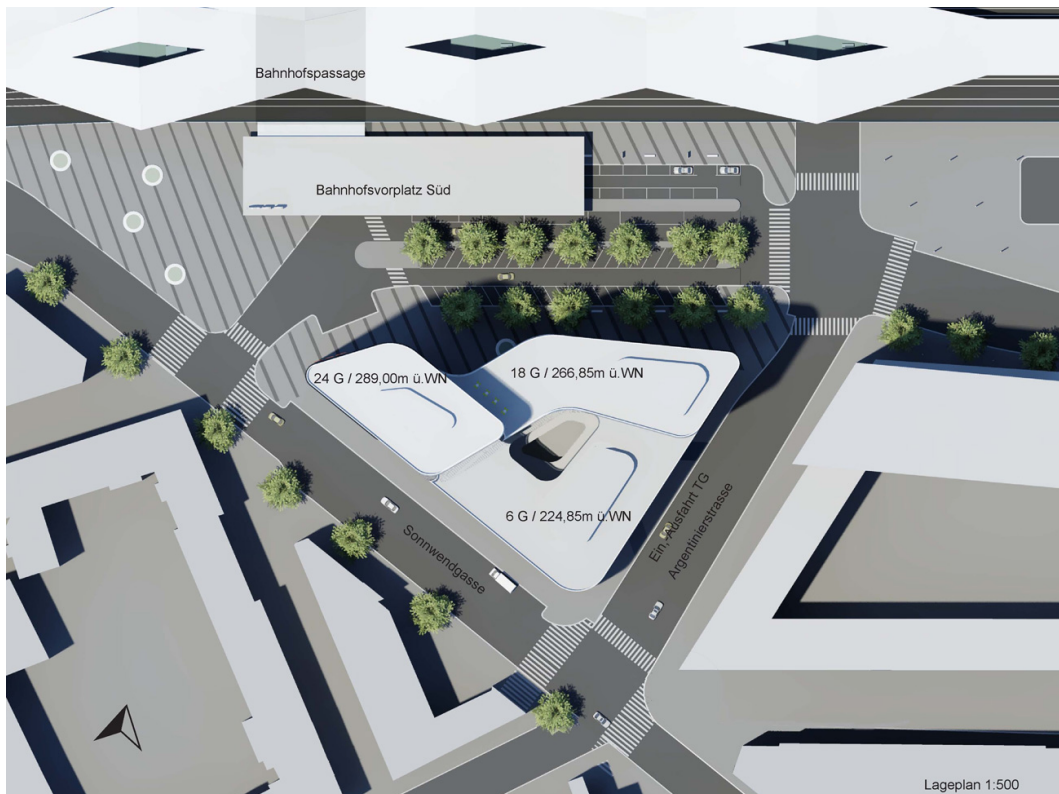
Lageplan ÖBB-Konzernzentrale⁷⁴
